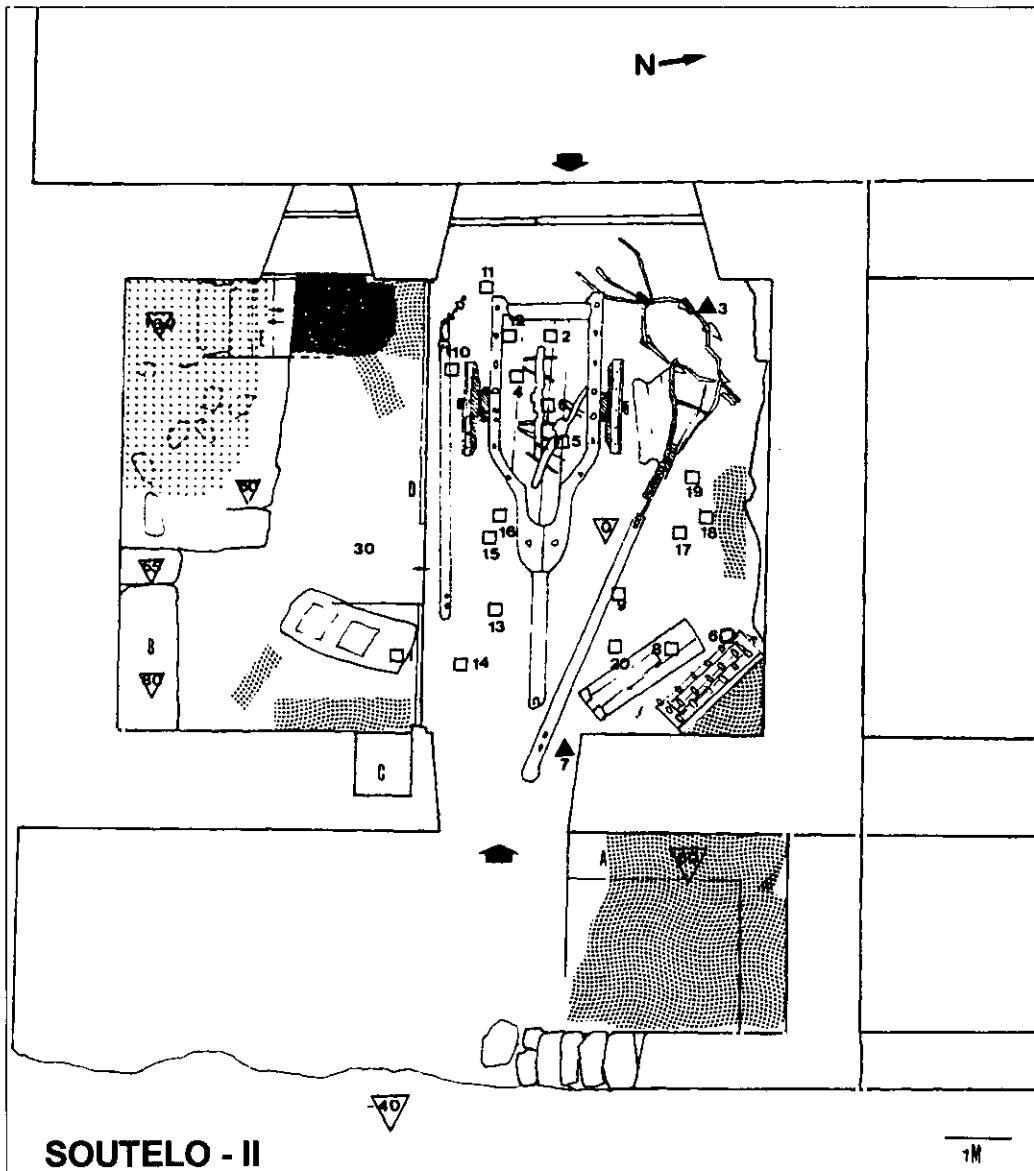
Plano de la planta baja de la vivienda Soutelo-2.
